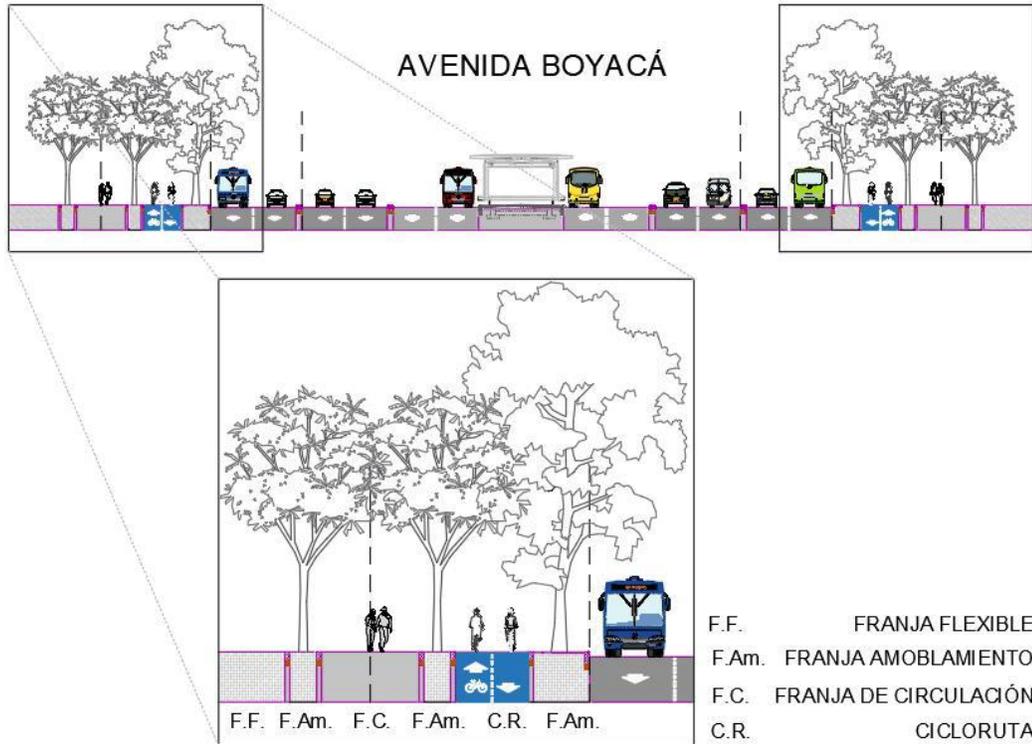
Perfil Vial (V-1) Av. Boyacá
